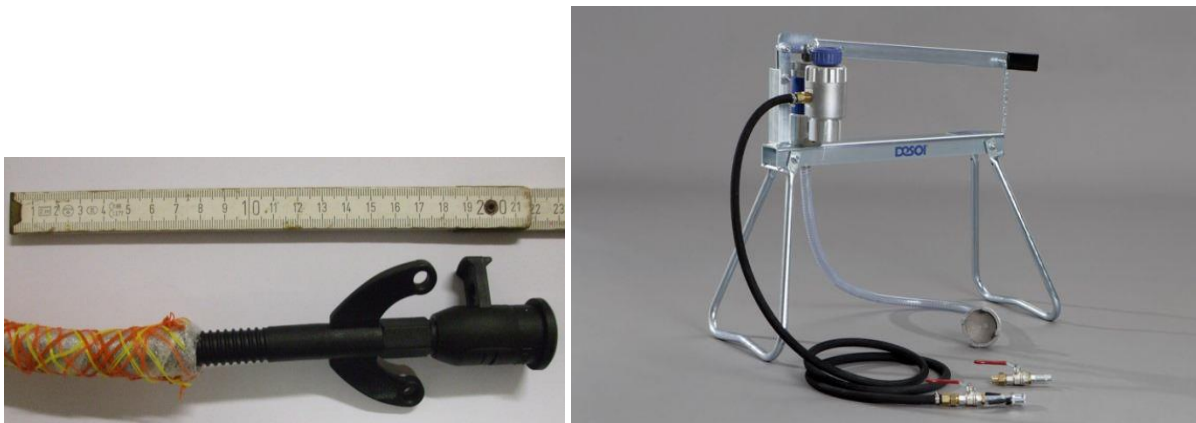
Links: Aufbau der Injektionstechnik. Von links nach rechts: Injektionsleitung Intec Cem N, Schraubpacker, Anschlussstück für die Pumpe mit Schieber zum Verschließen. Rechts: Handhebelkolbenpumpe HP-60ZD der Firma Desoi
